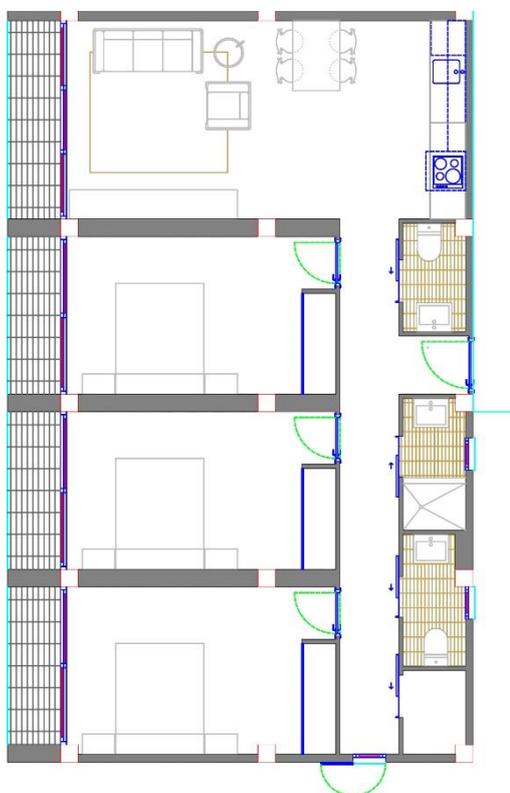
Planos de Viviendas-Tipo. Sin escala.
